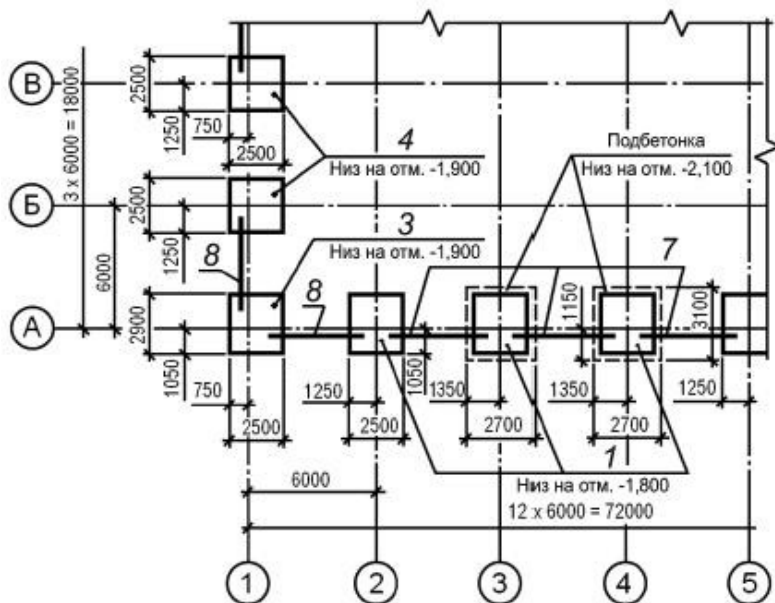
Пример фрагмента плана фундаментов производственного здания
